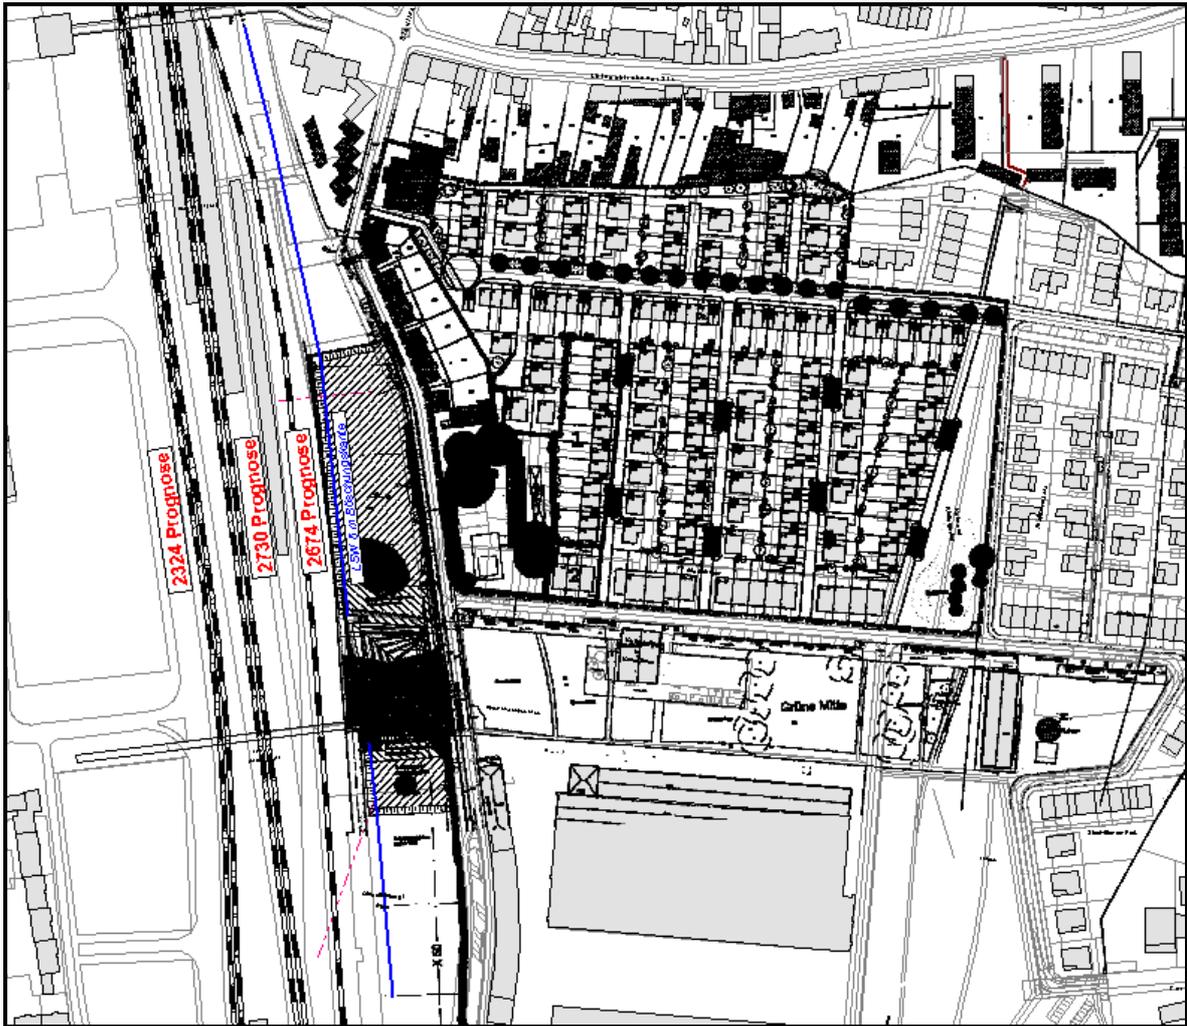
Situation mit 6 m hoher Lärmschutzwand (Fall 3)
